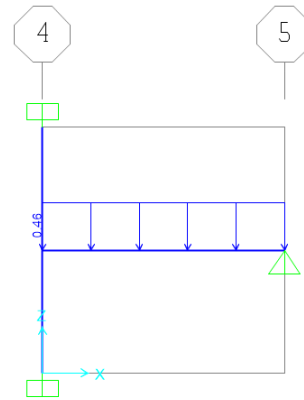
Modelo estructural de vigueta tipo III (ton/m)
